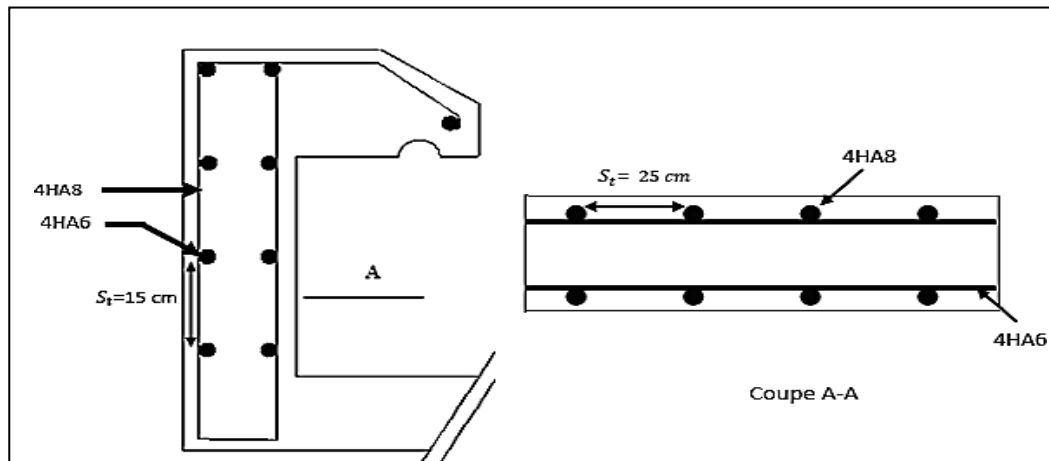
Schéma de ferrailage d'un acrotère.
